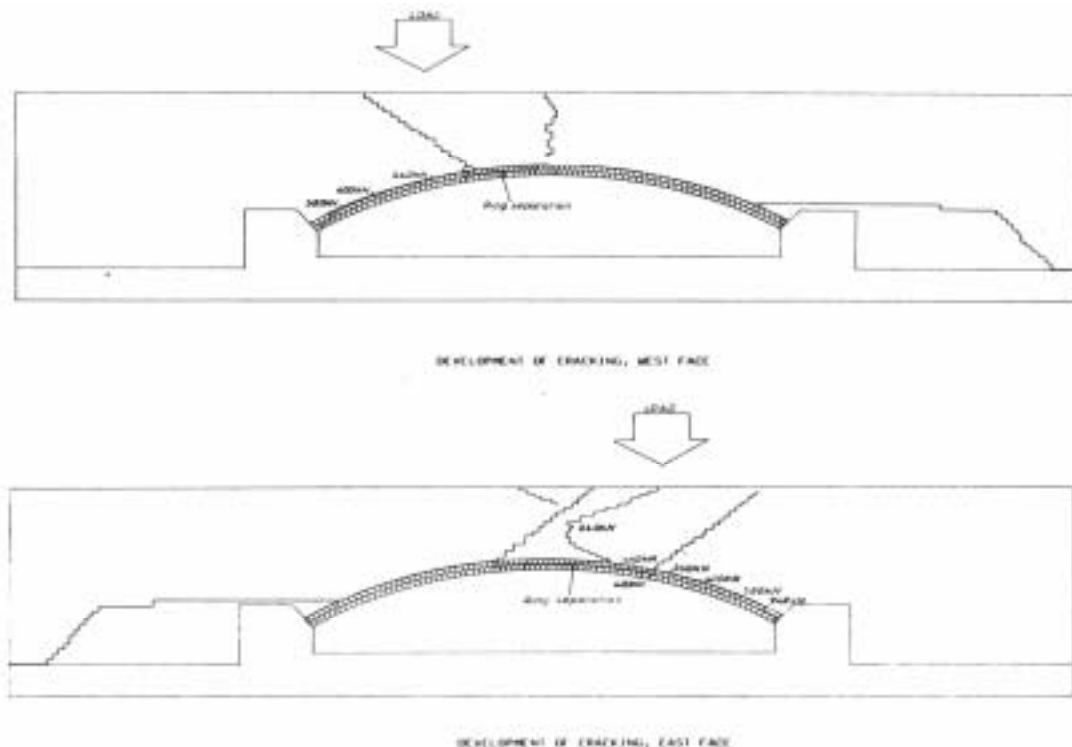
Desarrollo de las fisuras en el puente rebajado ensayado en el Bolton Insitute[14].
